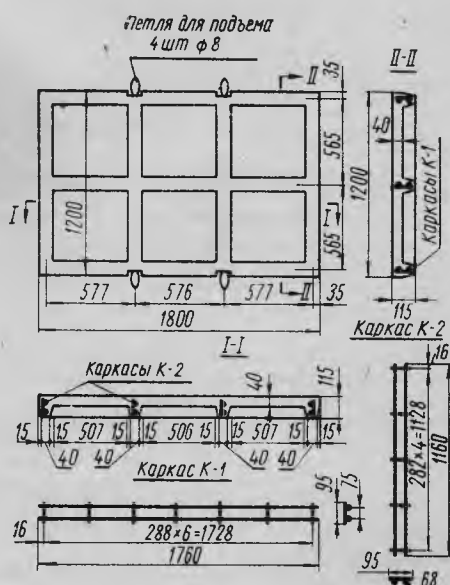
Ребристая железобетонная плита крепления марки П-120×180, марка бетона БГТ-200 (размеры в мм).
